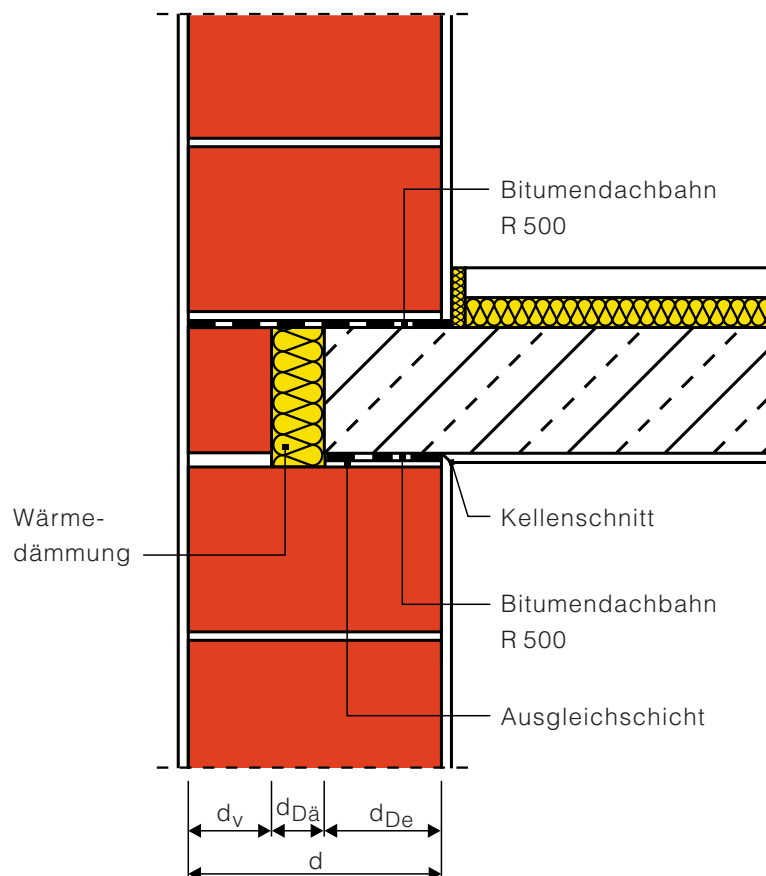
Ausführungsbeispiel eines typischen Außenwand-Decken-Knotens in einschaligem Ziegelmauerwerk
